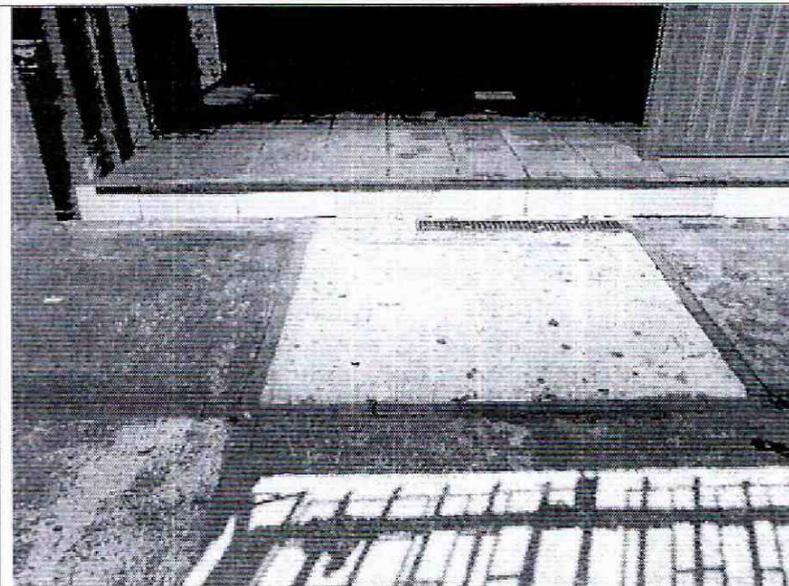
Piso en mortero afinado, sin daño con deterioro.
